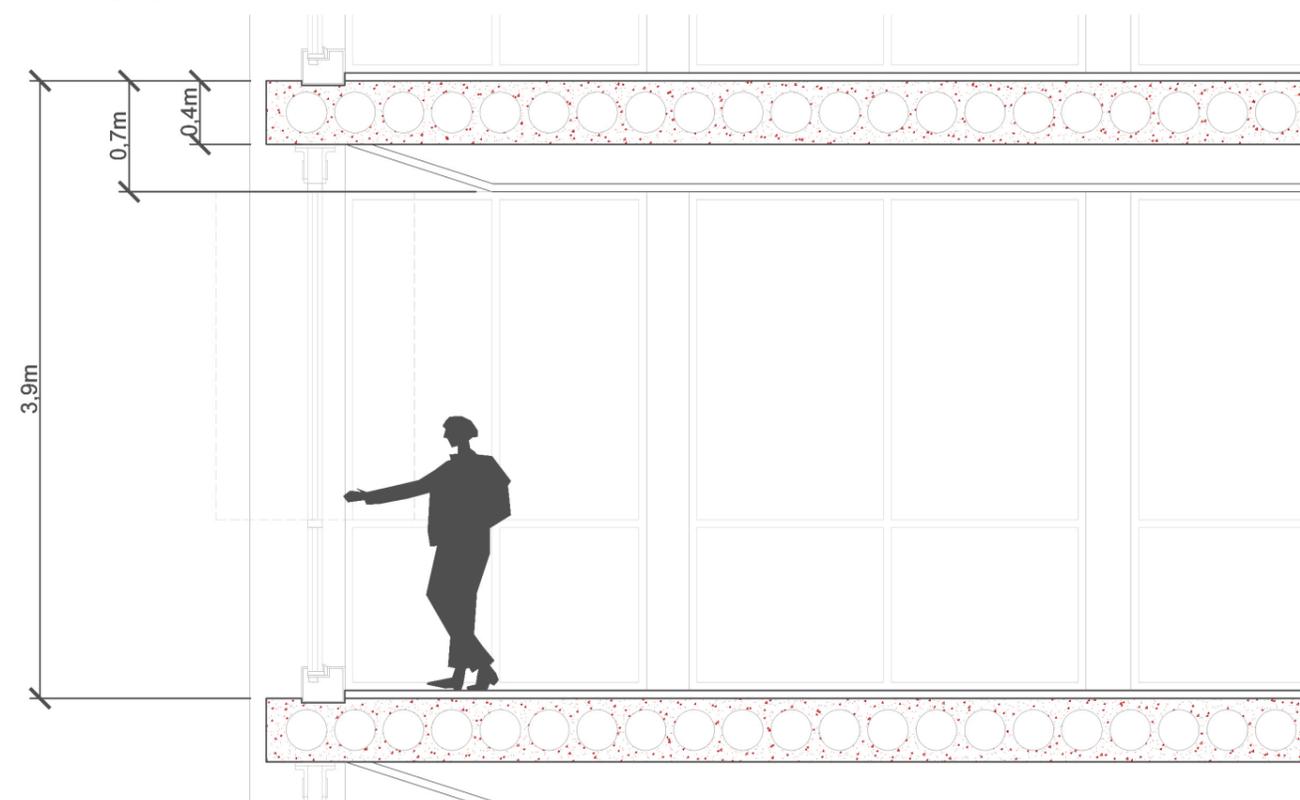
Espessura da laje alveolar, forro e pé direito do pavimento tipo. Autoria própria, 2022.
